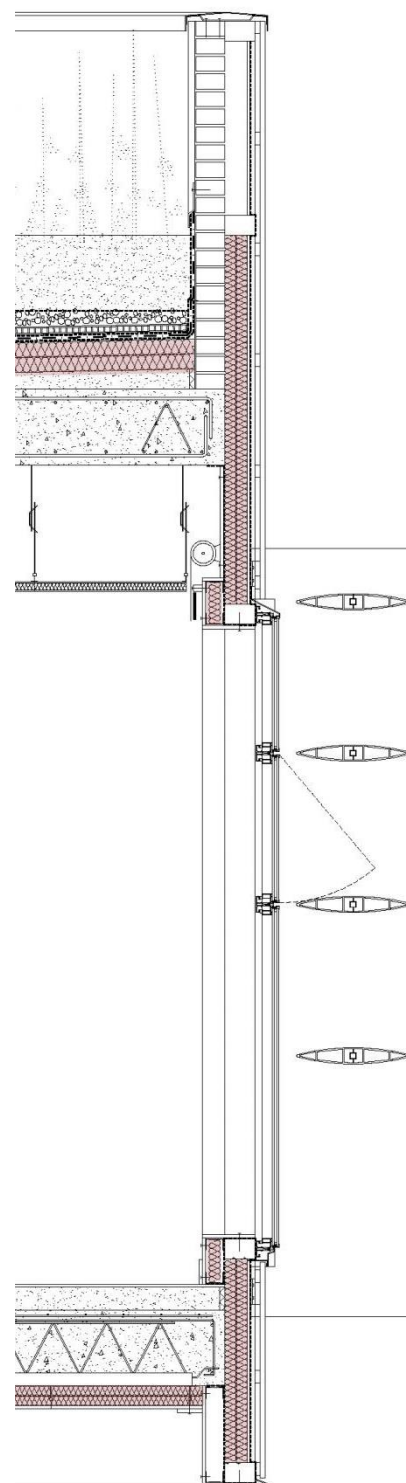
Sección constructiva del proyecto. Escala 1:30. Fuente: documentación del proyecto.
